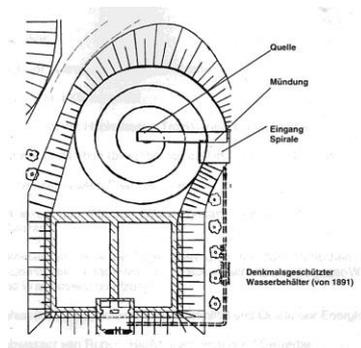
Grundriss von Wasserturm und Wasserhochbehälter
